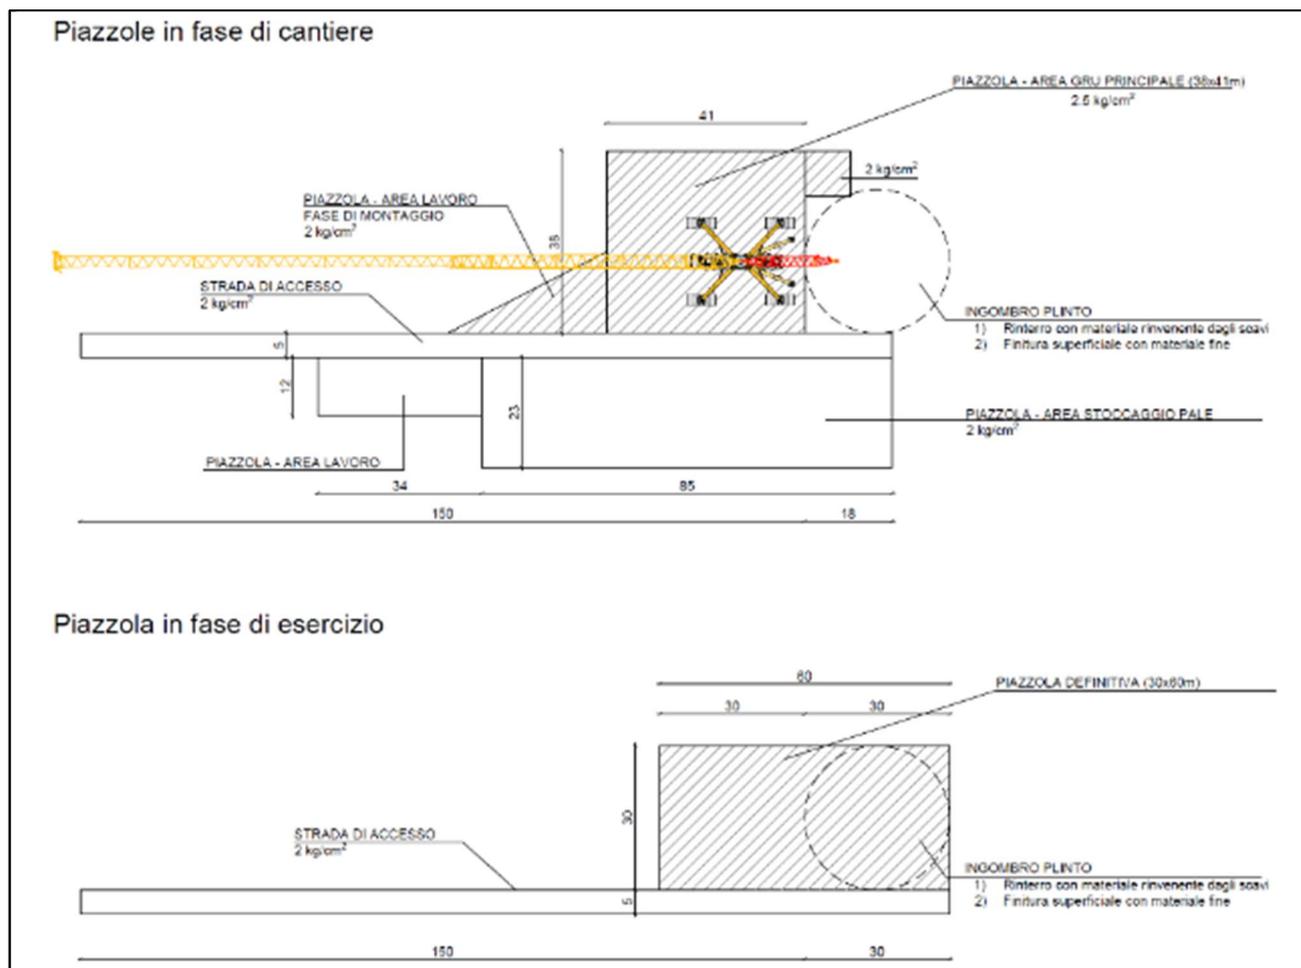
Planimetria piazzola tipo per la fase di installazione e fase di esercizio e manutenzione
